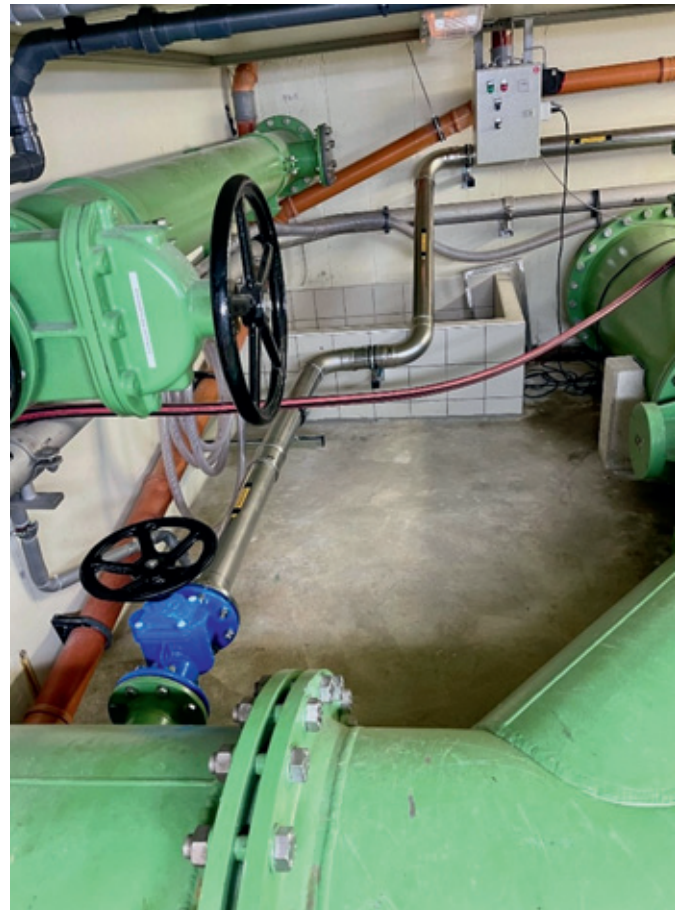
und 74: Angepasste Rohrleitungsführung im vorhandenen Bestand
